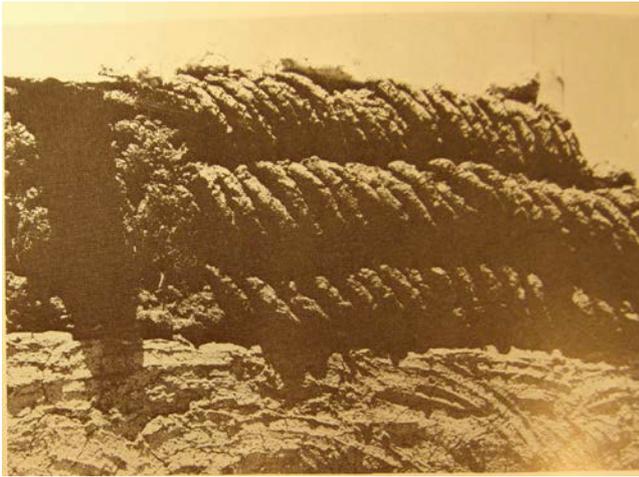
Getrocknete Yakfladen formen ein Parapet am Dach (Meyer/Jest 1987 c)
